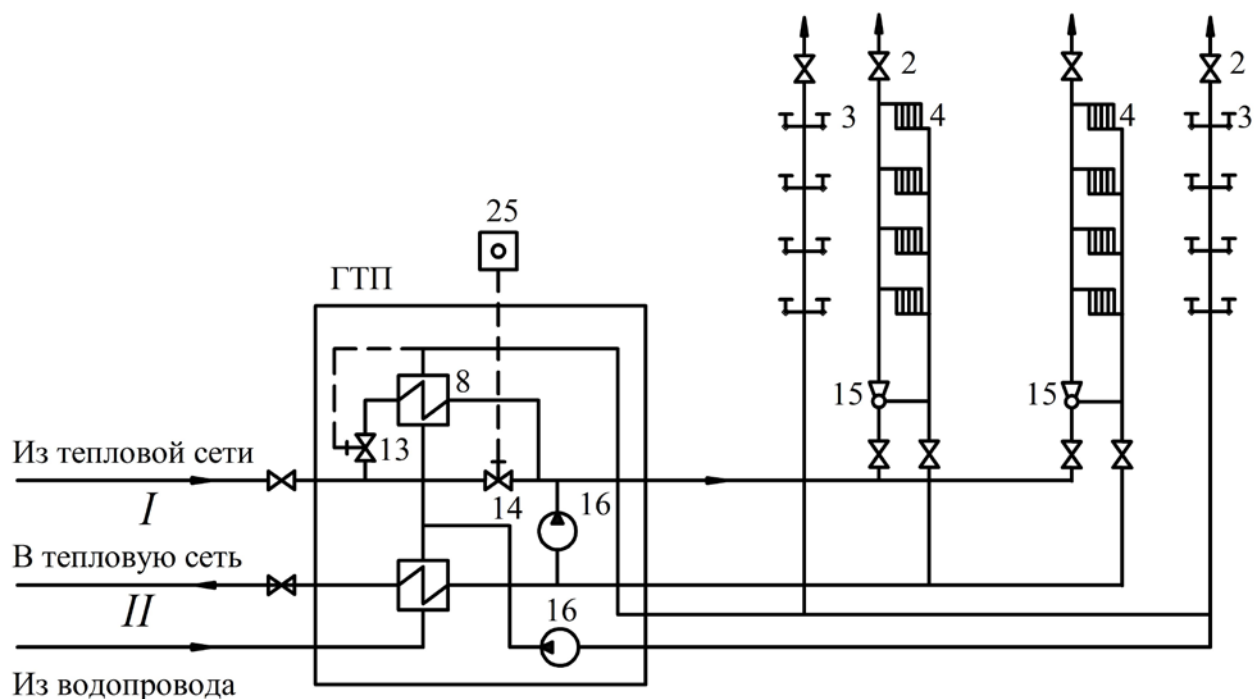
Схема присоединения к тепловой сети через ГТП отопительных установок и систем горячего водоснабжения группы зданий
